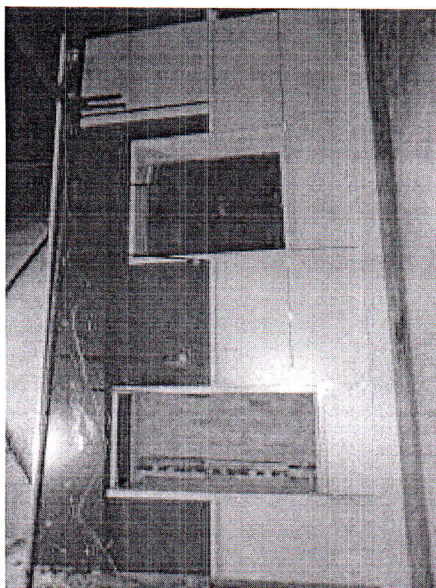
Б. Образец фасада до испытания по ГОСТ 31251-2008.
